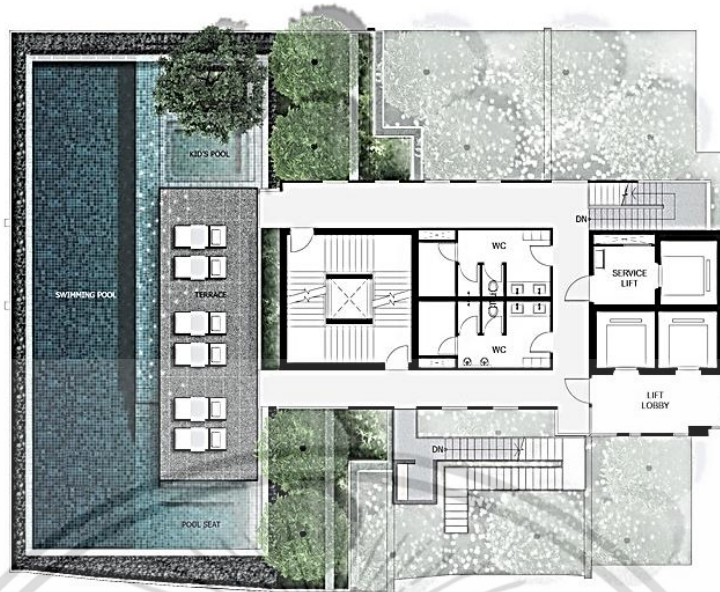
ผังโครงการ The Monument ชั้น 10 - 21
